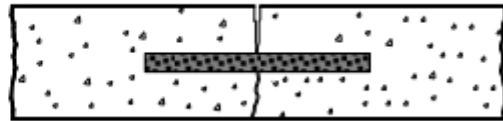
Junta transversal de contracción con pasadores. (Fuente: Instituto del Cemento Portland Argentino).
